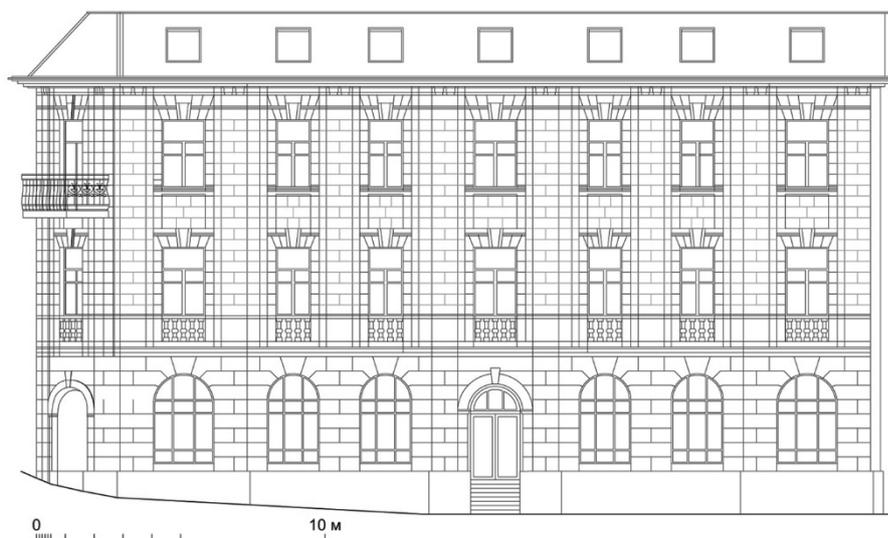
Здание отеля Европа (1900-е). Фасад со стороны ул. Светланской
